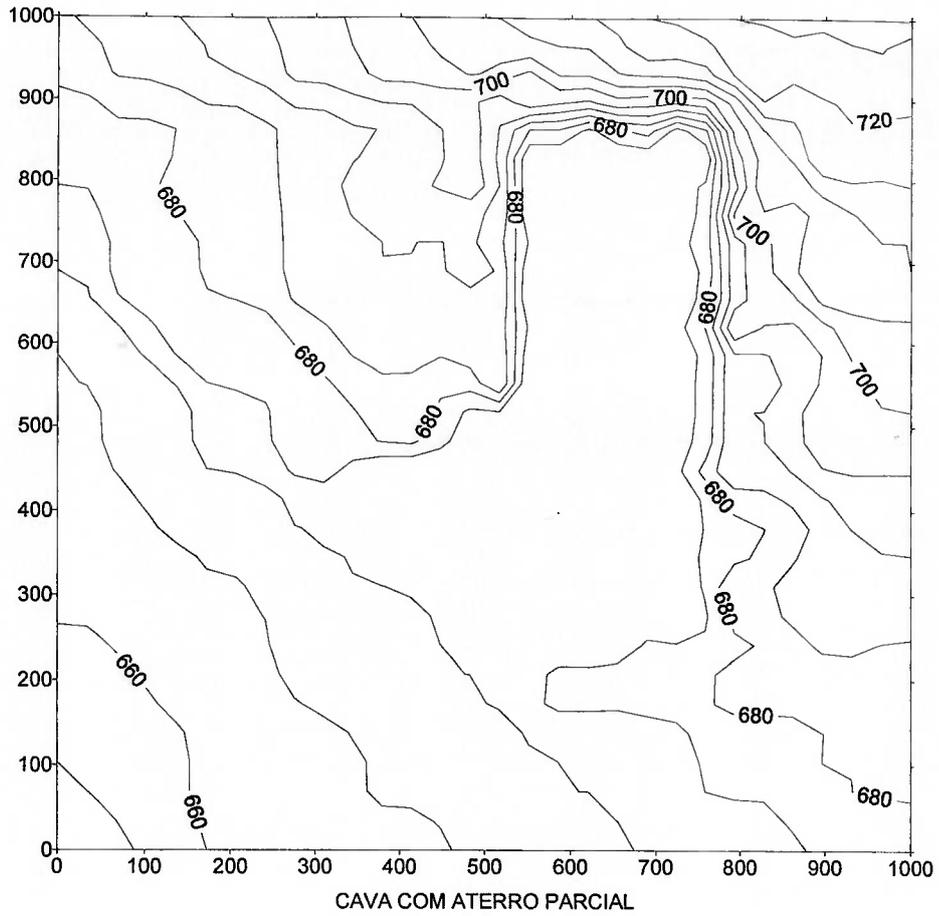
Planta planialtimétrica da área após aterro parcial
